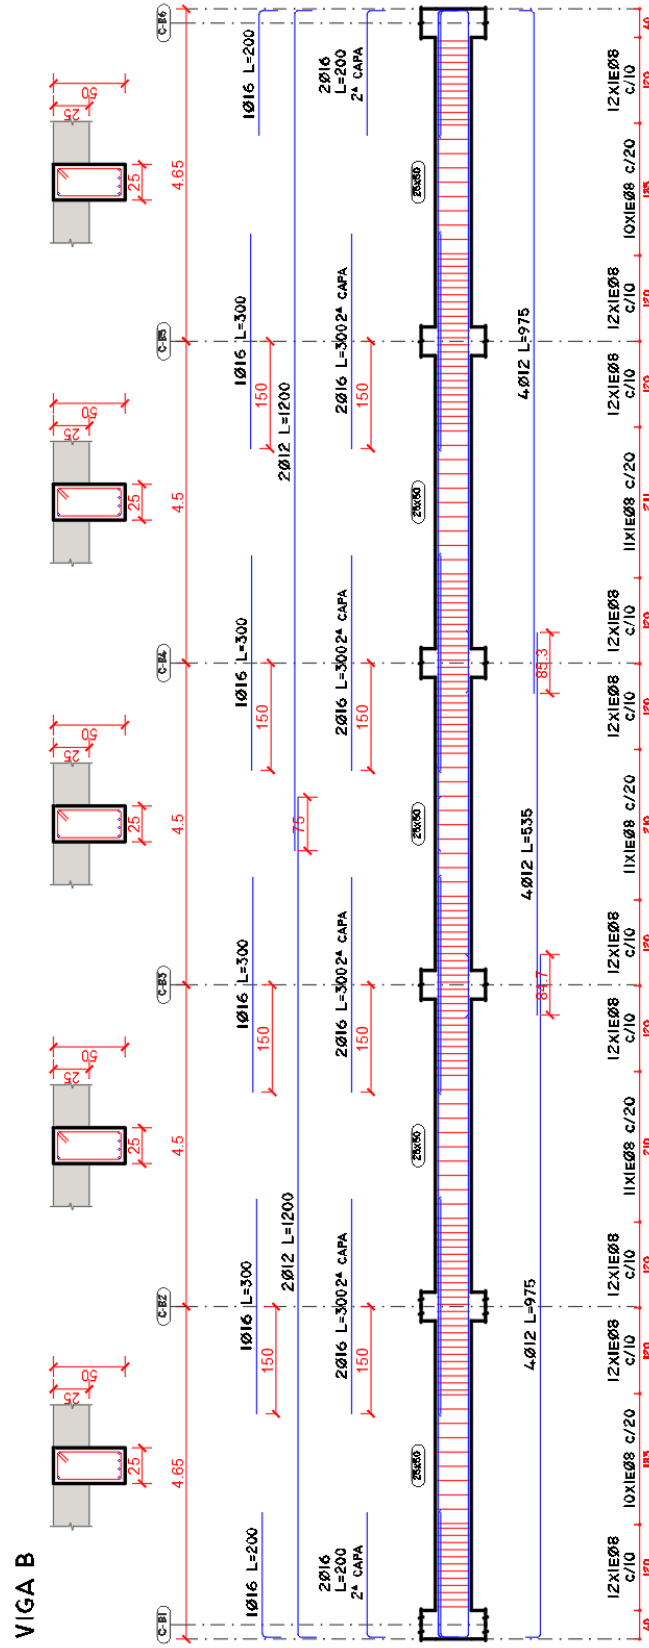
Detalle de Refuerzo Vigas en "Y" Losa 5 a 7 Estructura [7N-EE].
